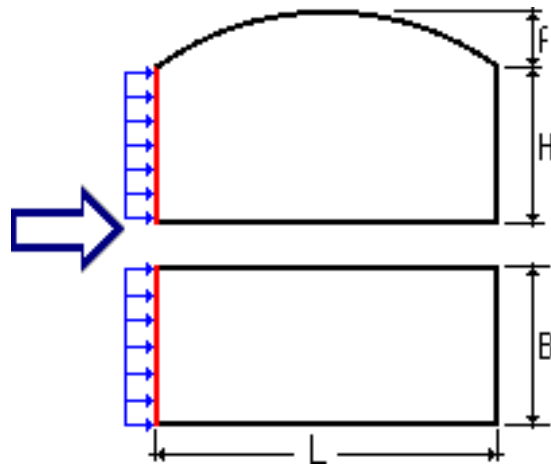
Схема будівлі з напрямком вітрового впливу
